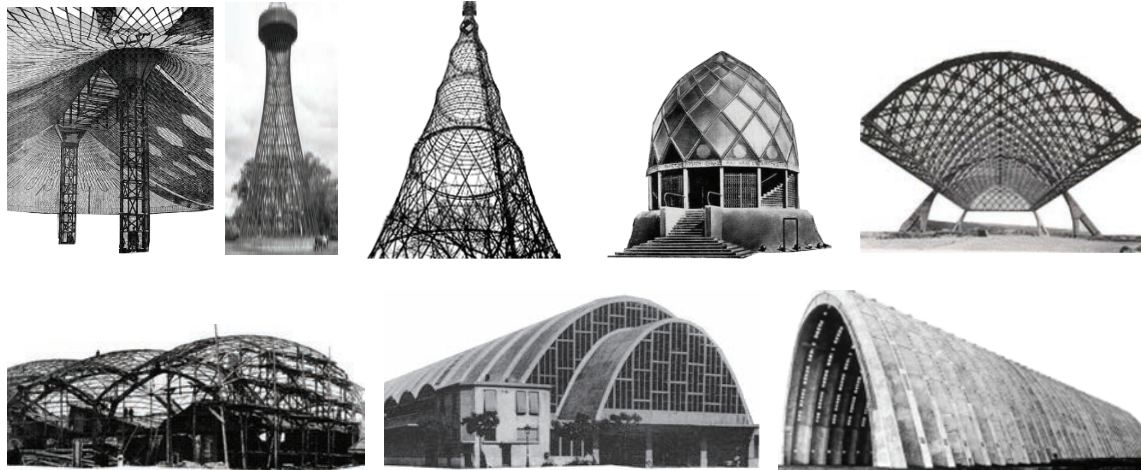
Proyectos de nervaduras estructurales: Las torres de Shukhov (1896 y 1911); Palacio de Cristal (Taut, 1914); Air Force - Eight Airplane Hangars (Nervi, 1935 – 42). Columna inferior: 1st. double curvatura surface (Shukhov, 1897); Airship Hangar (Freissenet, 1916).
